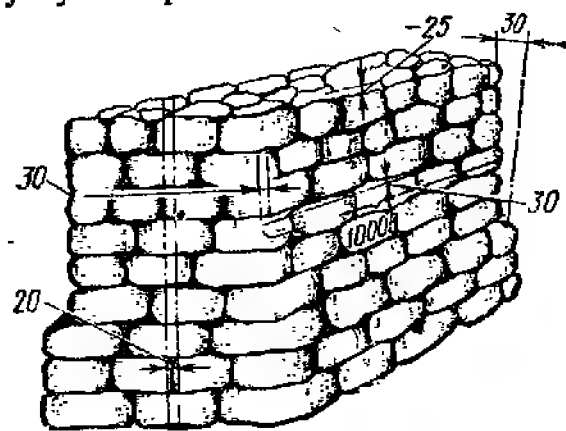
Допускаемые отклонения при кладке фундаментов из бутового камня (штрихпунктирными линиями обозначены границы допускаемых отклонений)
